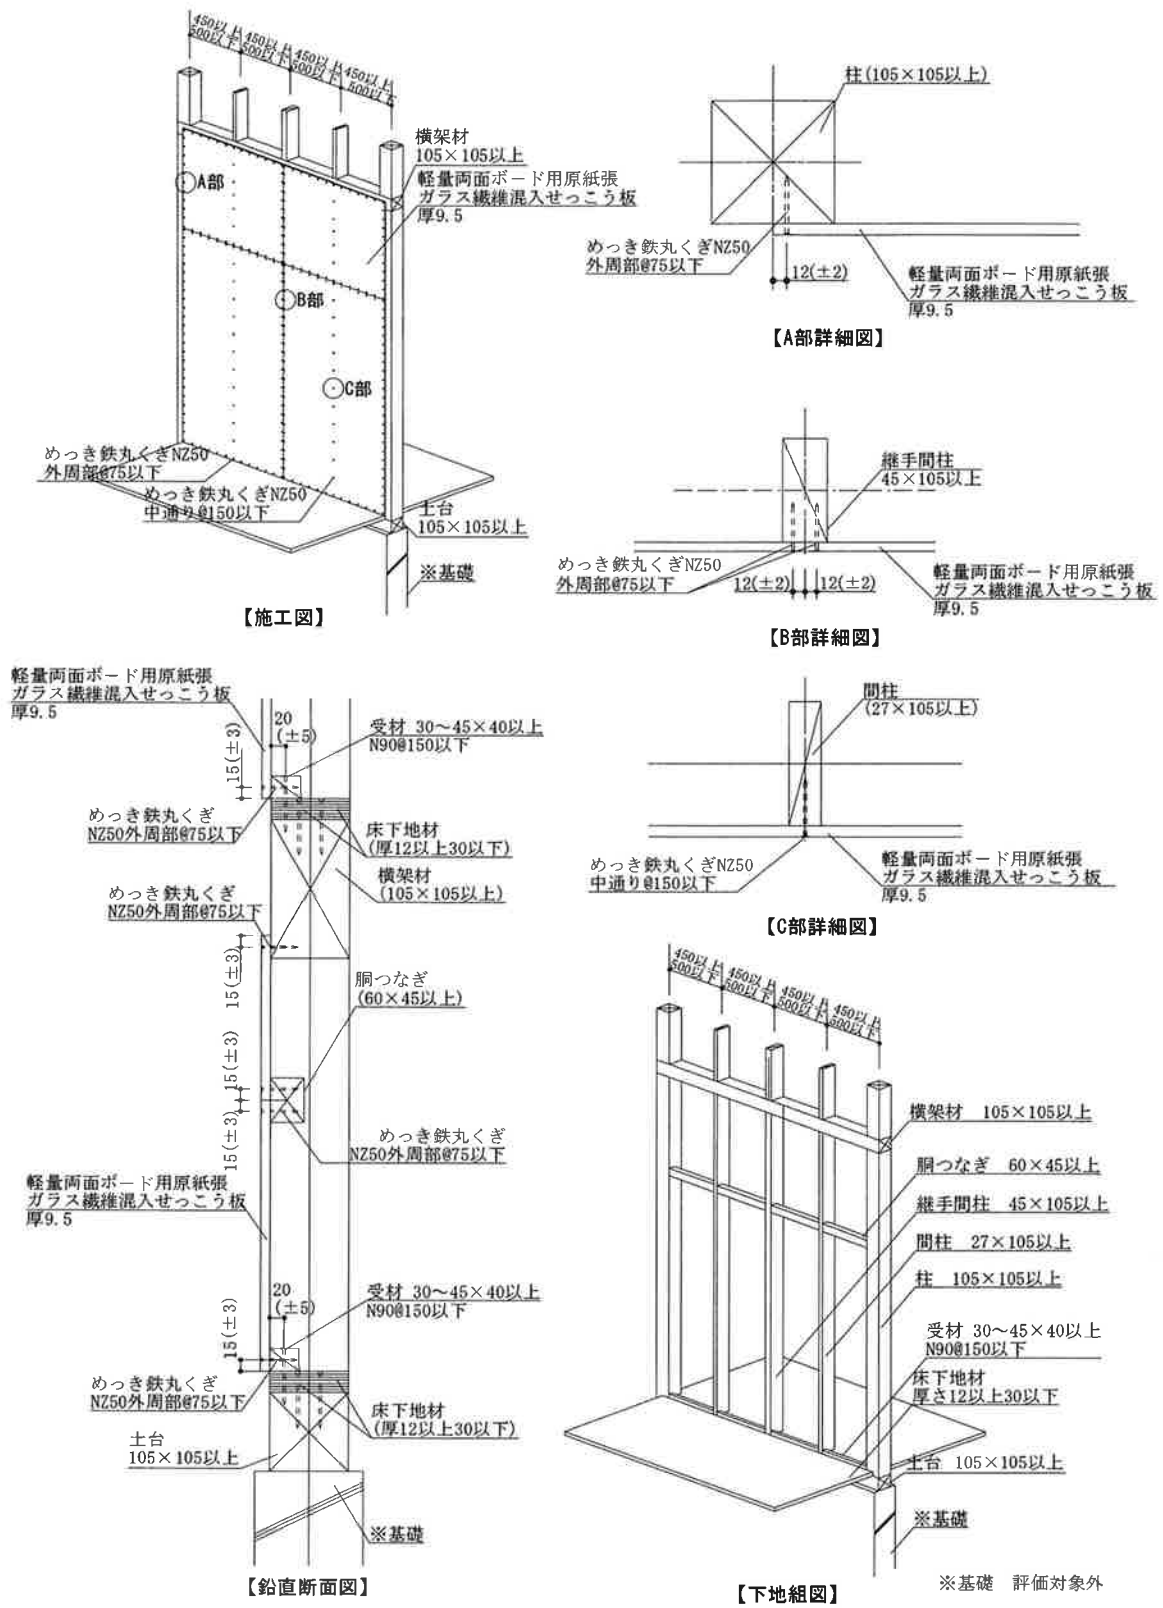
施工詳細図：縦継ぎ張りの場合 (寸法単位：mm)
